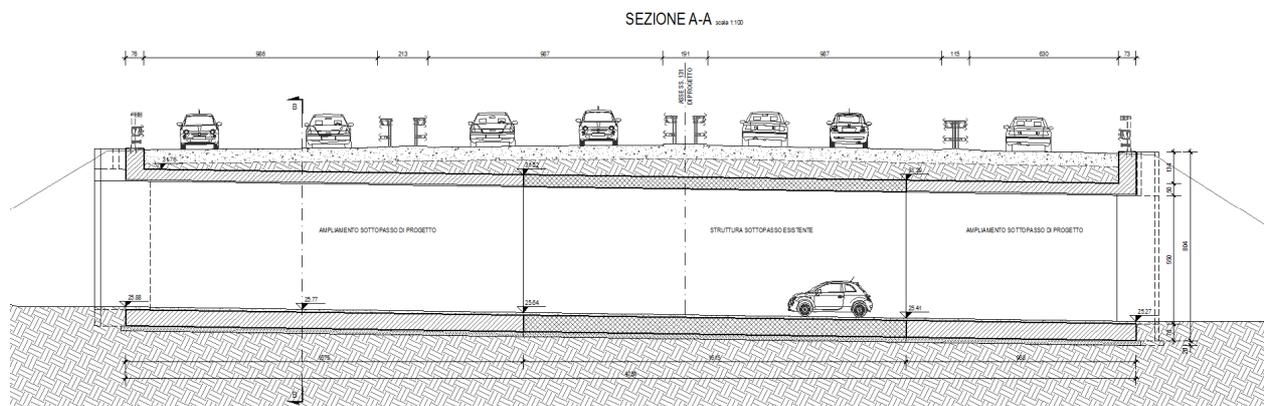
Sezione longitudinale in asse sottovia – Sottovia svincolo SS.131dir
